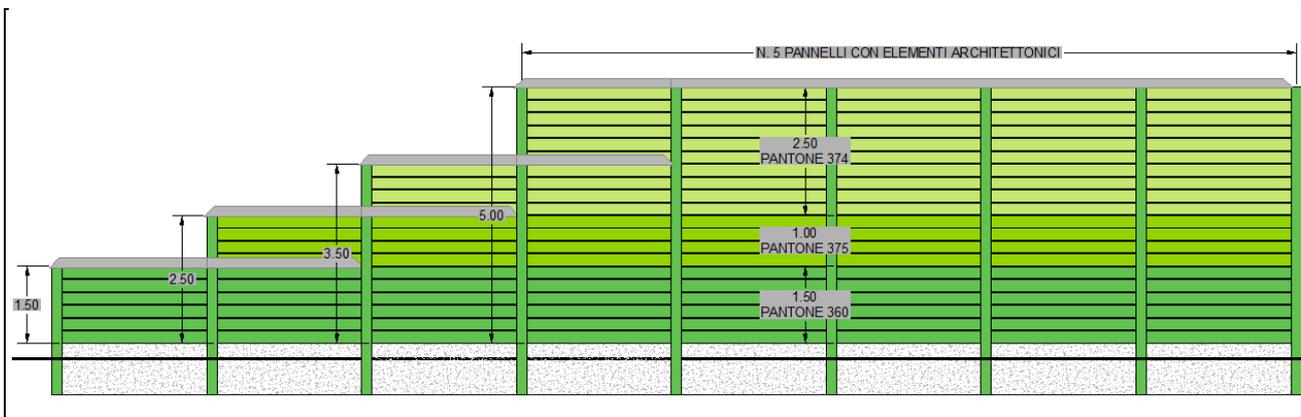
PROSPETTO TIPO ELEMENTI ARCHITETTONICI PER BARRIERA ANTIRUMORE H 5,0 M
